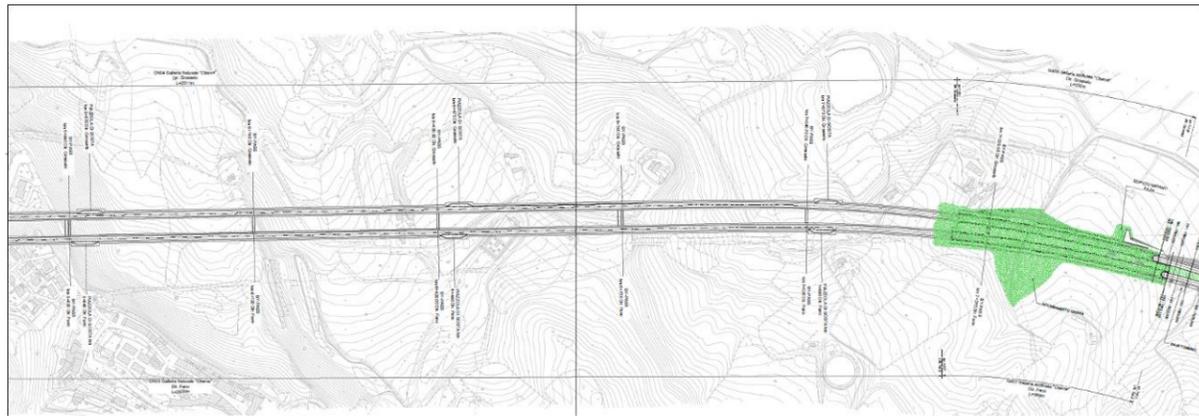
Stralcio planimetrico della galleria " Citerna" – 2° parte
